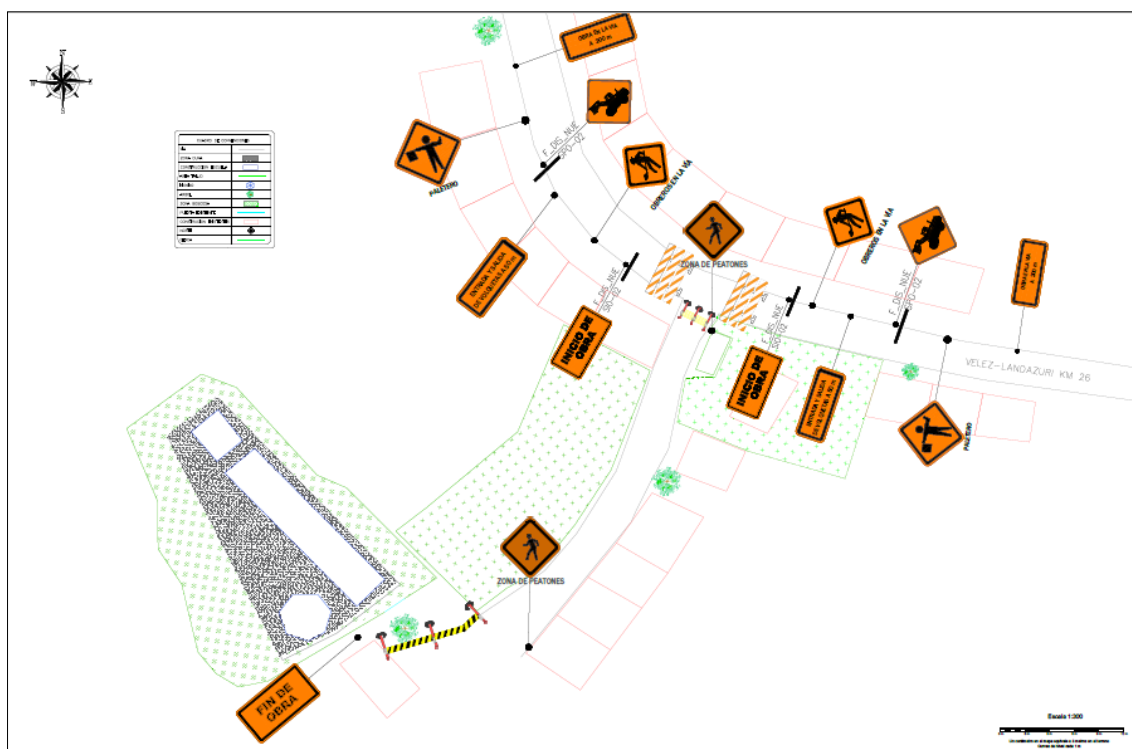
Vista en planta del plan de manejo de tránsito. (AutoCAD, Fuente propia)
